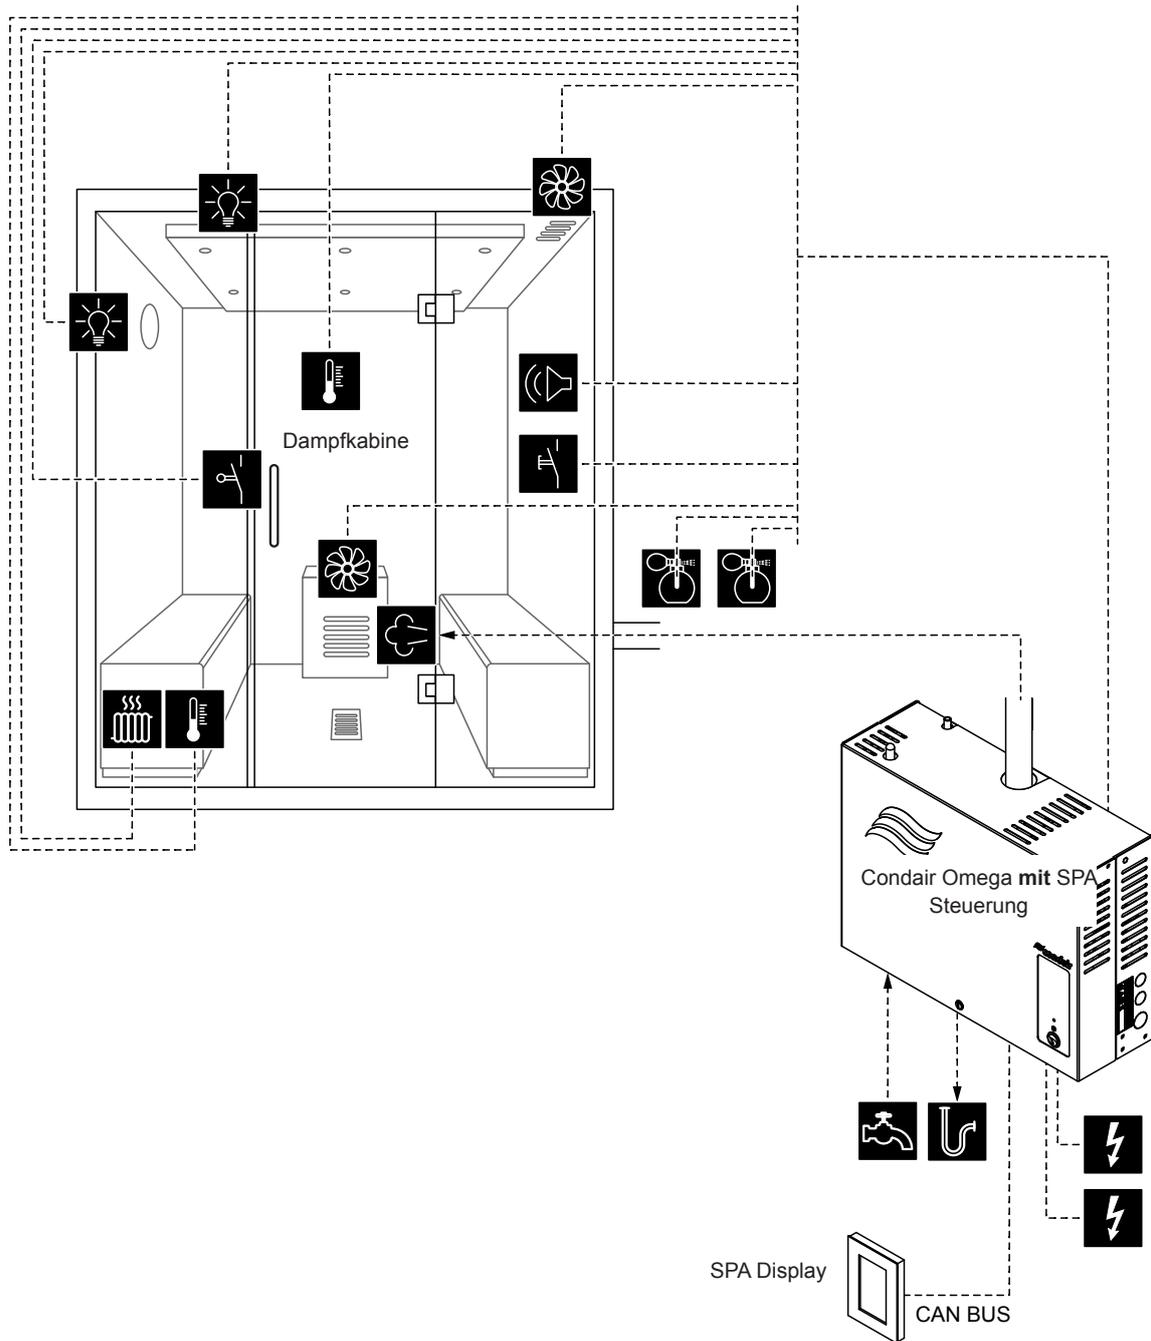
Condair Omega mit SPA Steuerung und Ausrüstung für Dampfbadanwendung mit optionaler Sitzbankheizung
